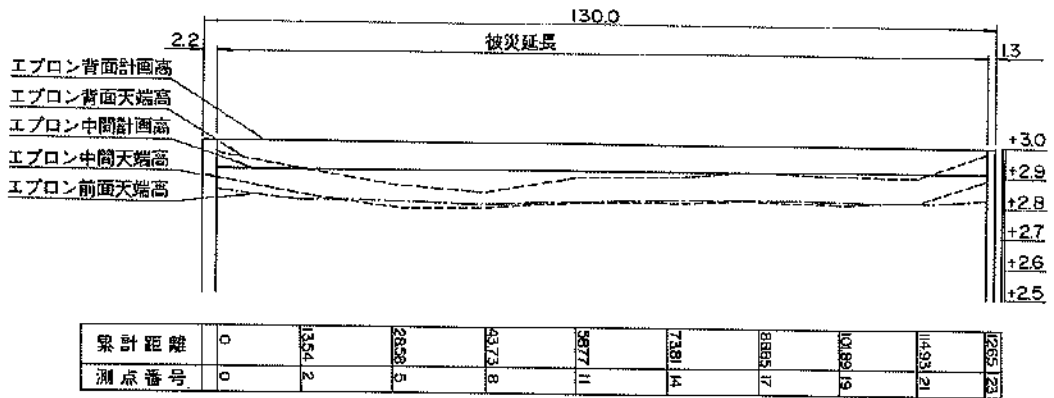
縦断面図 (浦河港, 岸壁(-7.5m))
